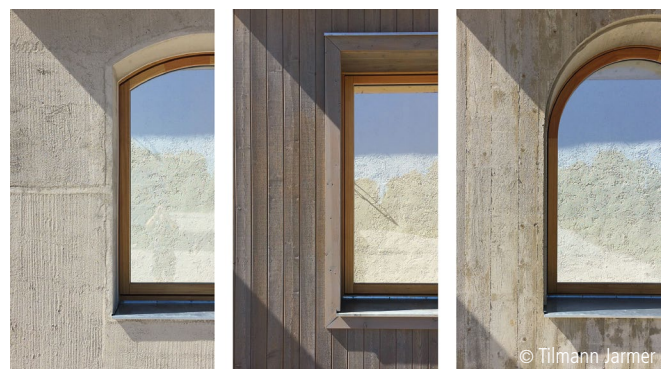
Fensterdetails der verschiedenen Bauweisen; Foto der Fassadenmodelle im Maßstab 1:1
